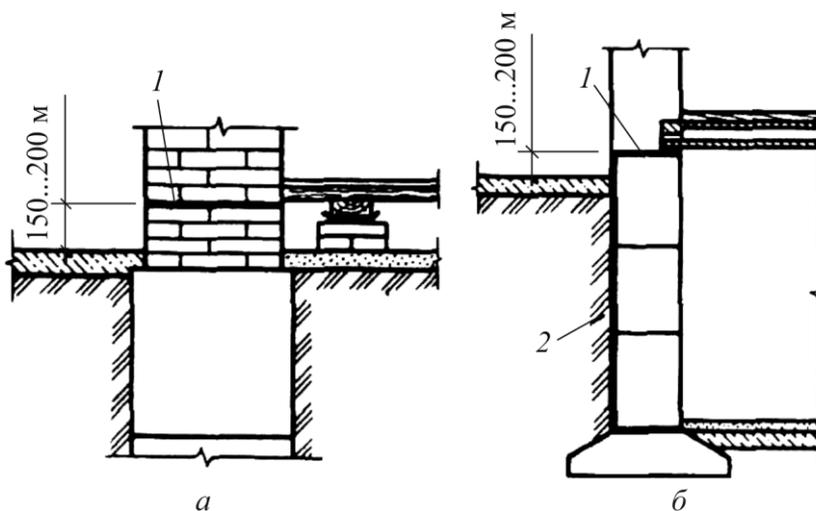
Изоляция стен от сырости: *а* – стена бесподвального здания; *б* – стена подвального помещения; 1 – цементный раствор или рулонный материал; 2 – обмазка битумом за два раза
